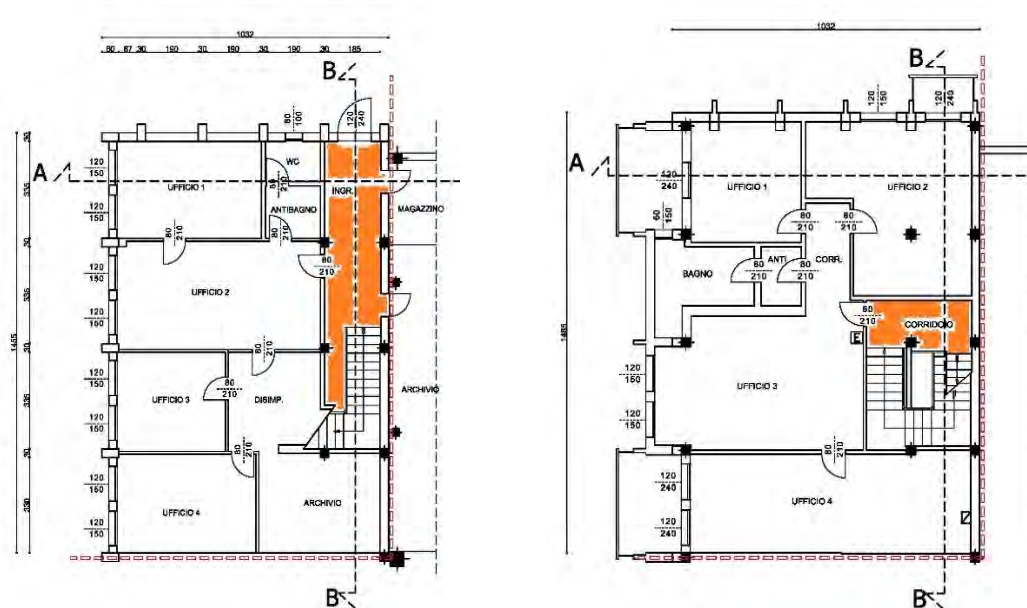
planimetria del progetto, sviluppata con software AutoCAD
